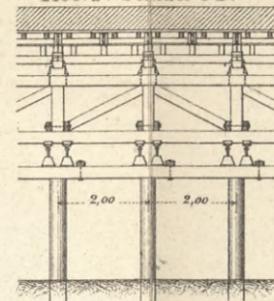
Gertraudten-Brücke, Berlin. 17^m w.
